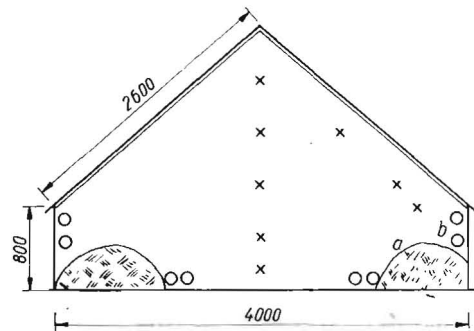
Lage der Meßpunkte im Spezialgurkenhaus; a Erdwall, b Heizrohre
